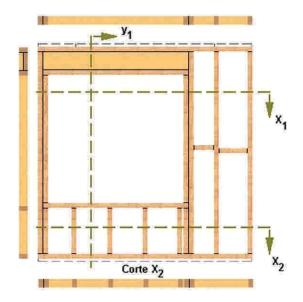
67: Elevación con información necesaria para la fabricación y montaje del tabique en obra.
